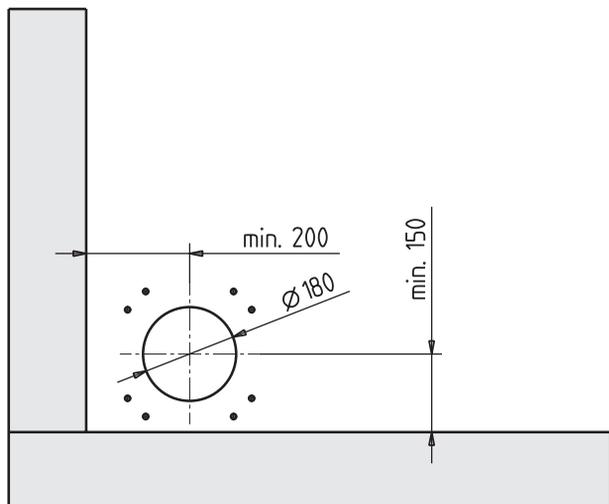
Foro nel muro a sinistra - vista anteriormente.
